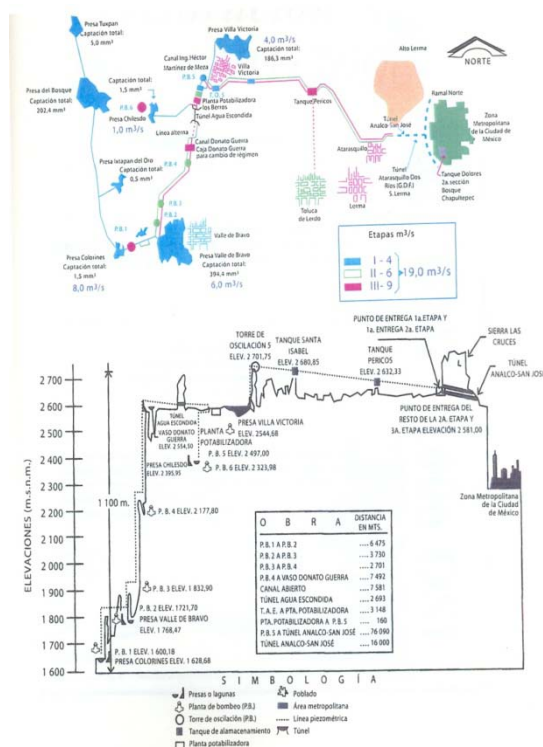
Vista general en planta y perfil del Sistema Cutzamala.
